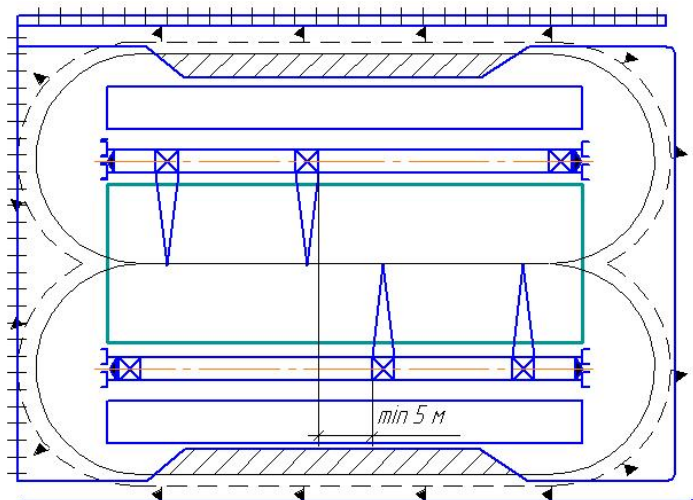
Фрагмент стройгенплана при совместной работе двух башенных кранов
